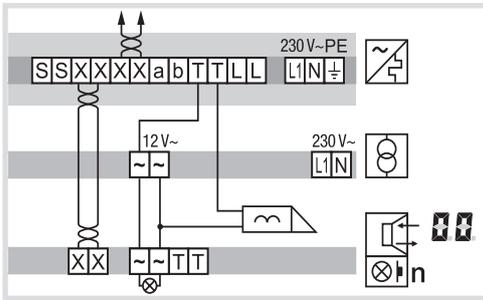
collegamento dell'apparechio con l'apriporta protetto contro le manomissioni
